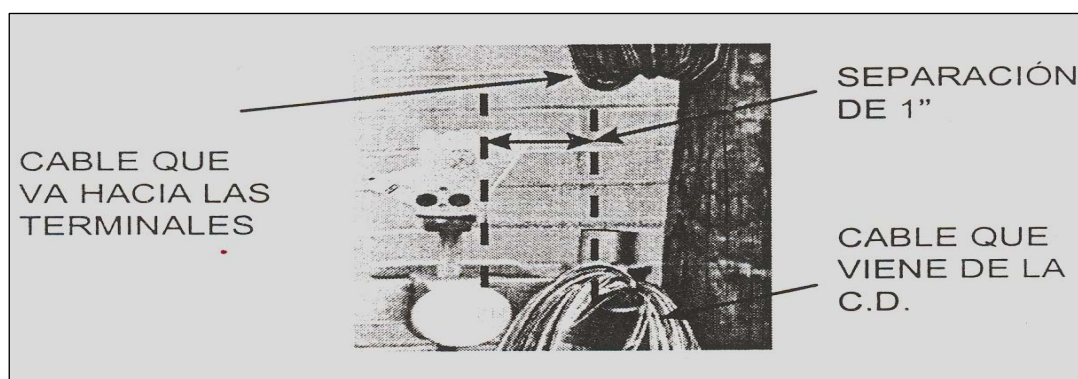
Separación del Cabezal y los Cables Para Empalme en Poste con el Cierre en Posición Vertical.
